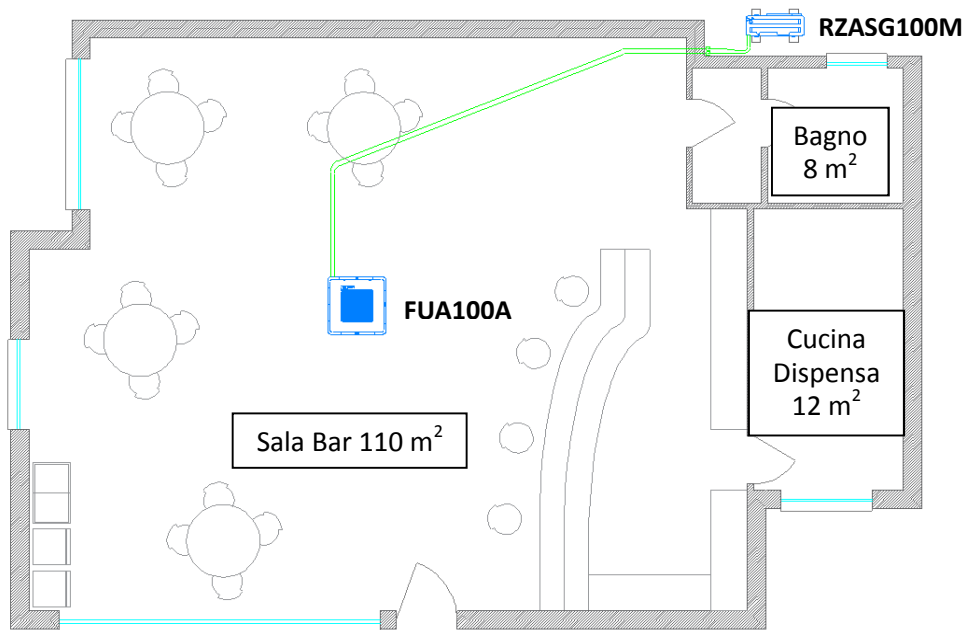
planimetria bar con sistema Sky Air serie Advance di taglia 100.
